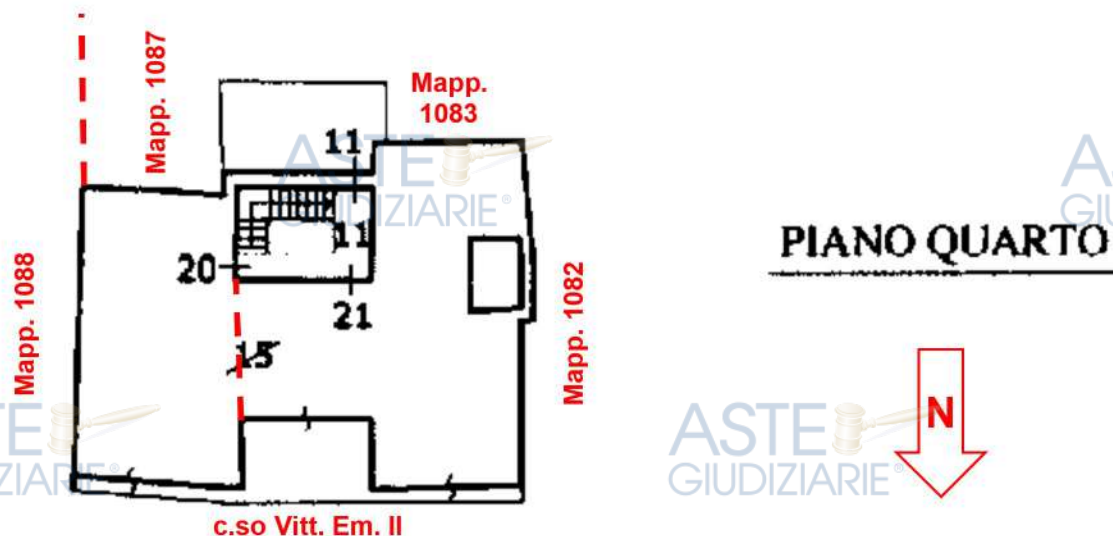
LOTTO 8. Stralcio elaborato planimetrico (fuori scala). Nord in basso
